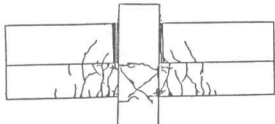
No.7(一面せん断型目地) 最終ひび割れ状況
